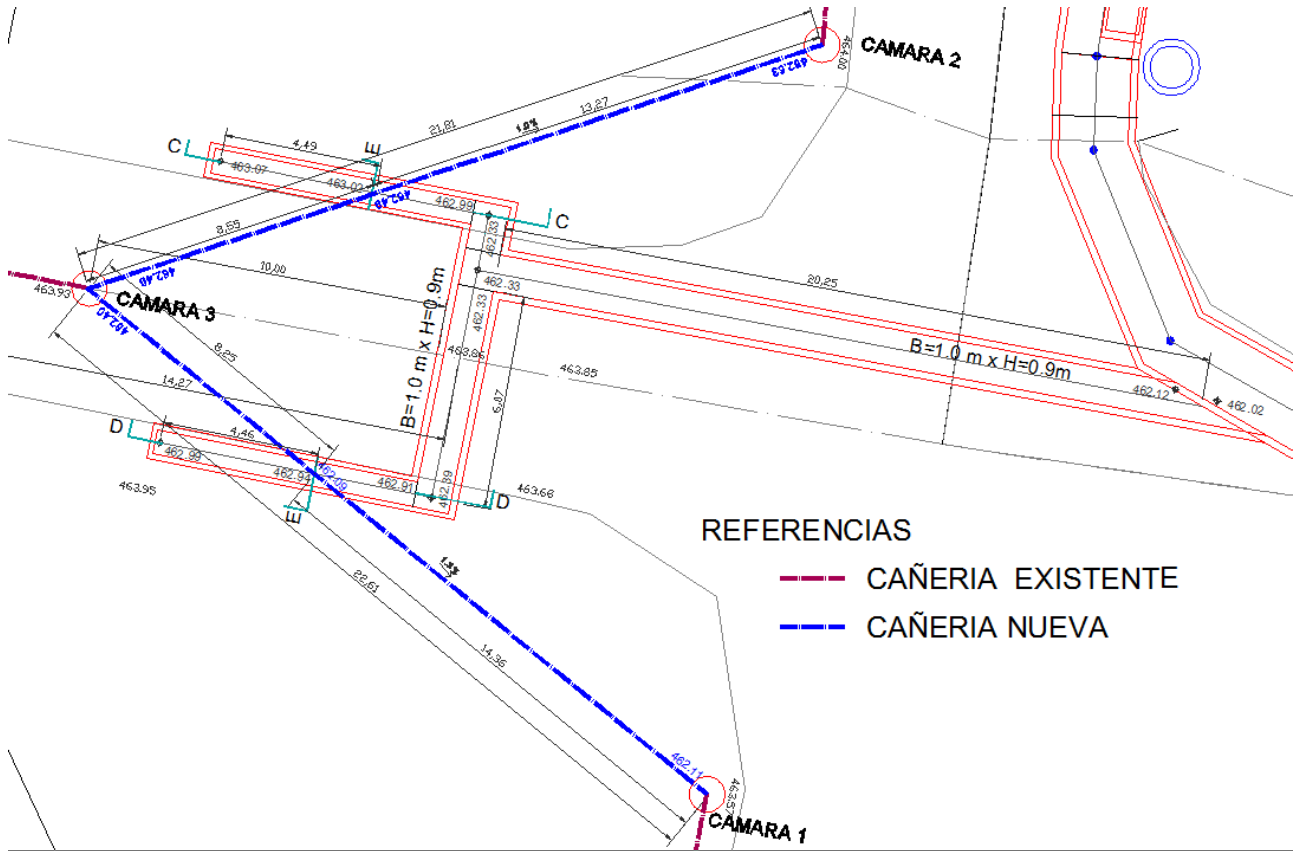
Planta. Propuesta. Cloaca RD-L
